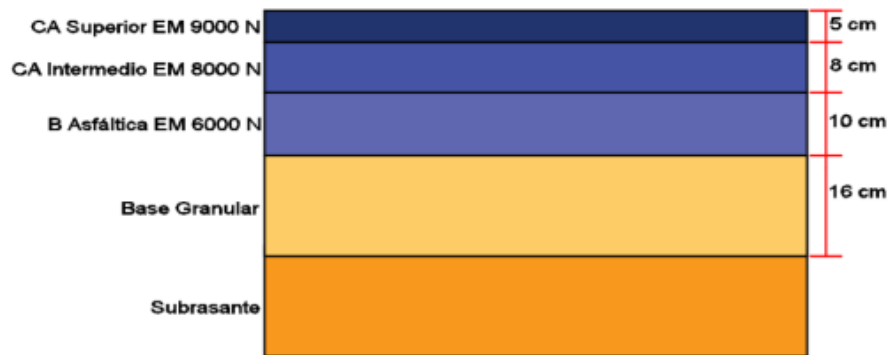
Estructura de Pavimento existente del Tramo 1 [25].
